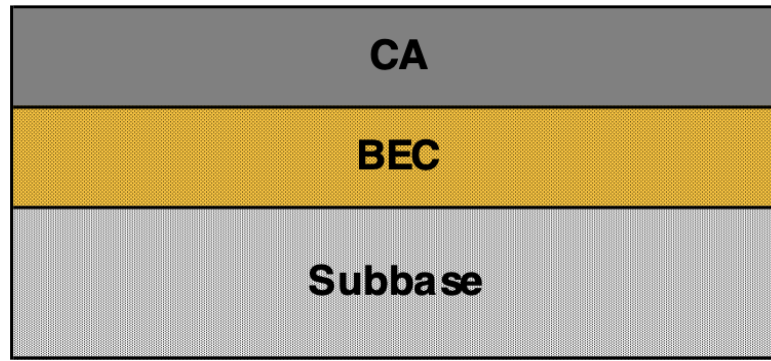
Sección transversal típica #1 de un pavimento compuesto. Fuente: Andrade Triviño y Franco Puga (2019).
